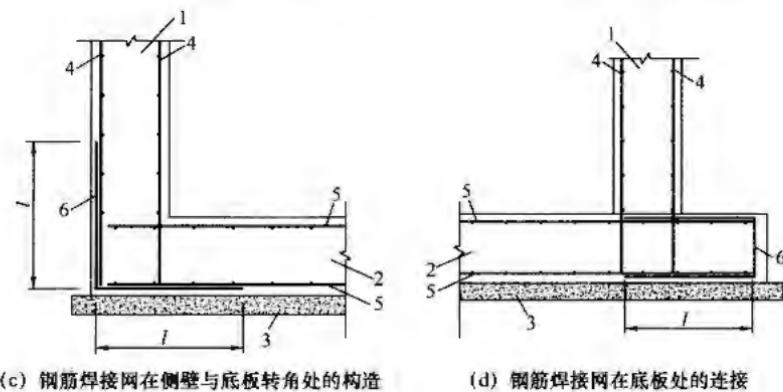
钢筋焊接网输水渠道构造及安装示意图
